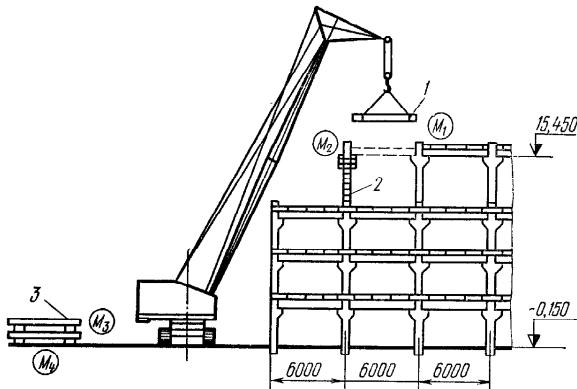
Организация рабочего места при монтаже ригелей промышленного многоэтажного здания:
